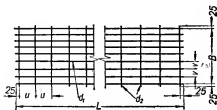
Сварная сетка с продольной рабочей арматурой.
